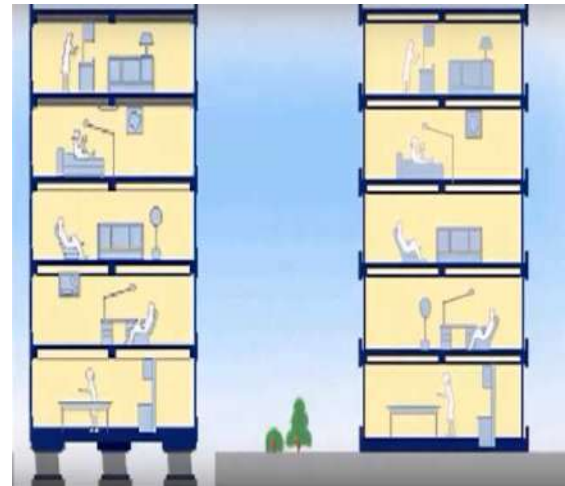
En la imagen podemos observar la estructura de lado izquierdo con aisladores, y en el lado derecho sin aisladores.
